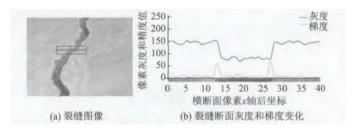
路面裂缝边缘特征 Fig. 4 Edge features of pavement crack
